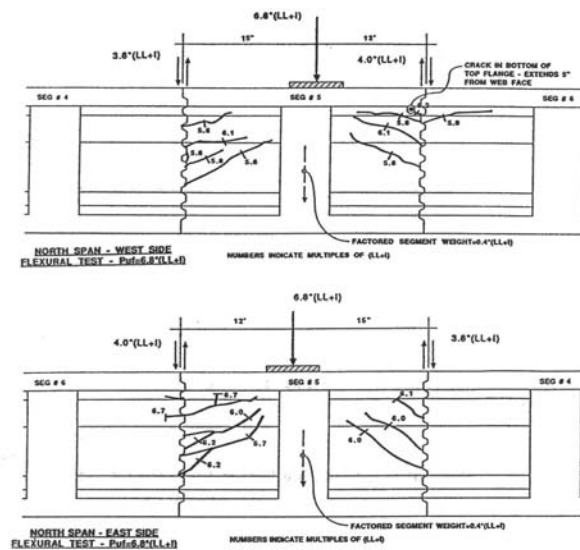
Fisuración observada en los ensayos de vigas continuas ante cargas concentradas [MACGREGOR (1989)].
